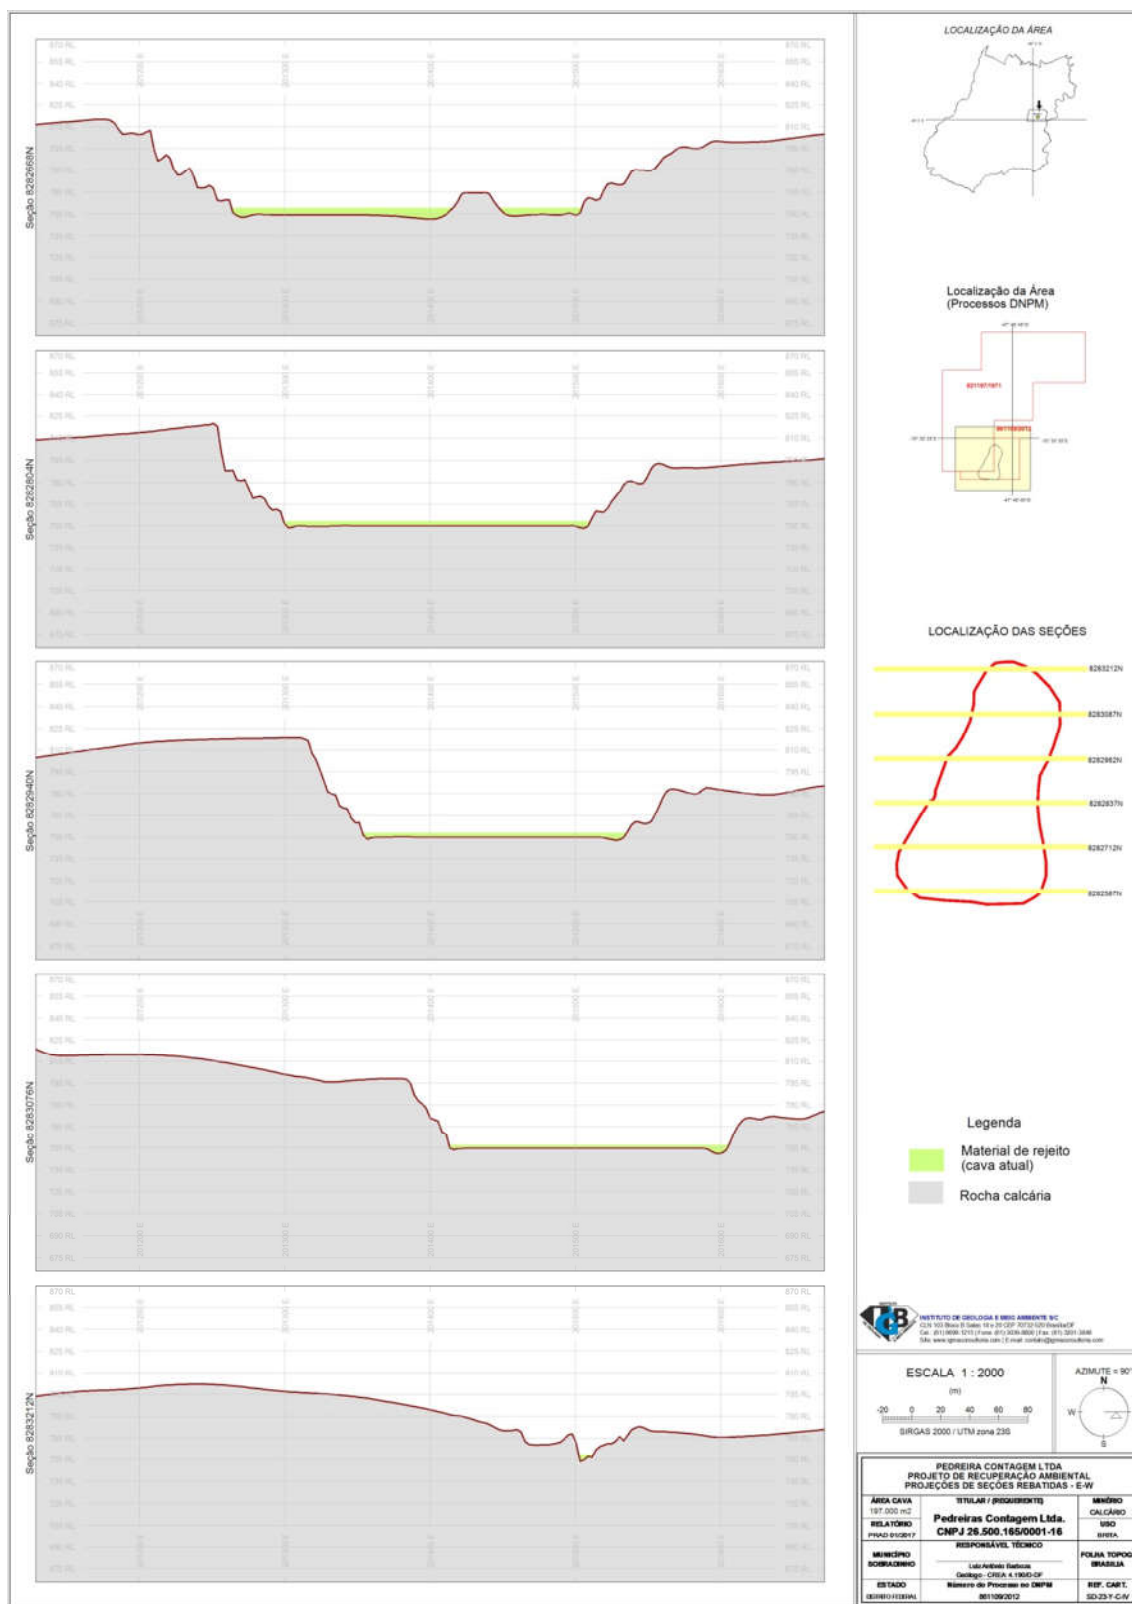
Processo DNPM 821.197/1971 – seções verticais rebatidas Sul-Norte, demonstrando preenchimento com estéril armazenado.
